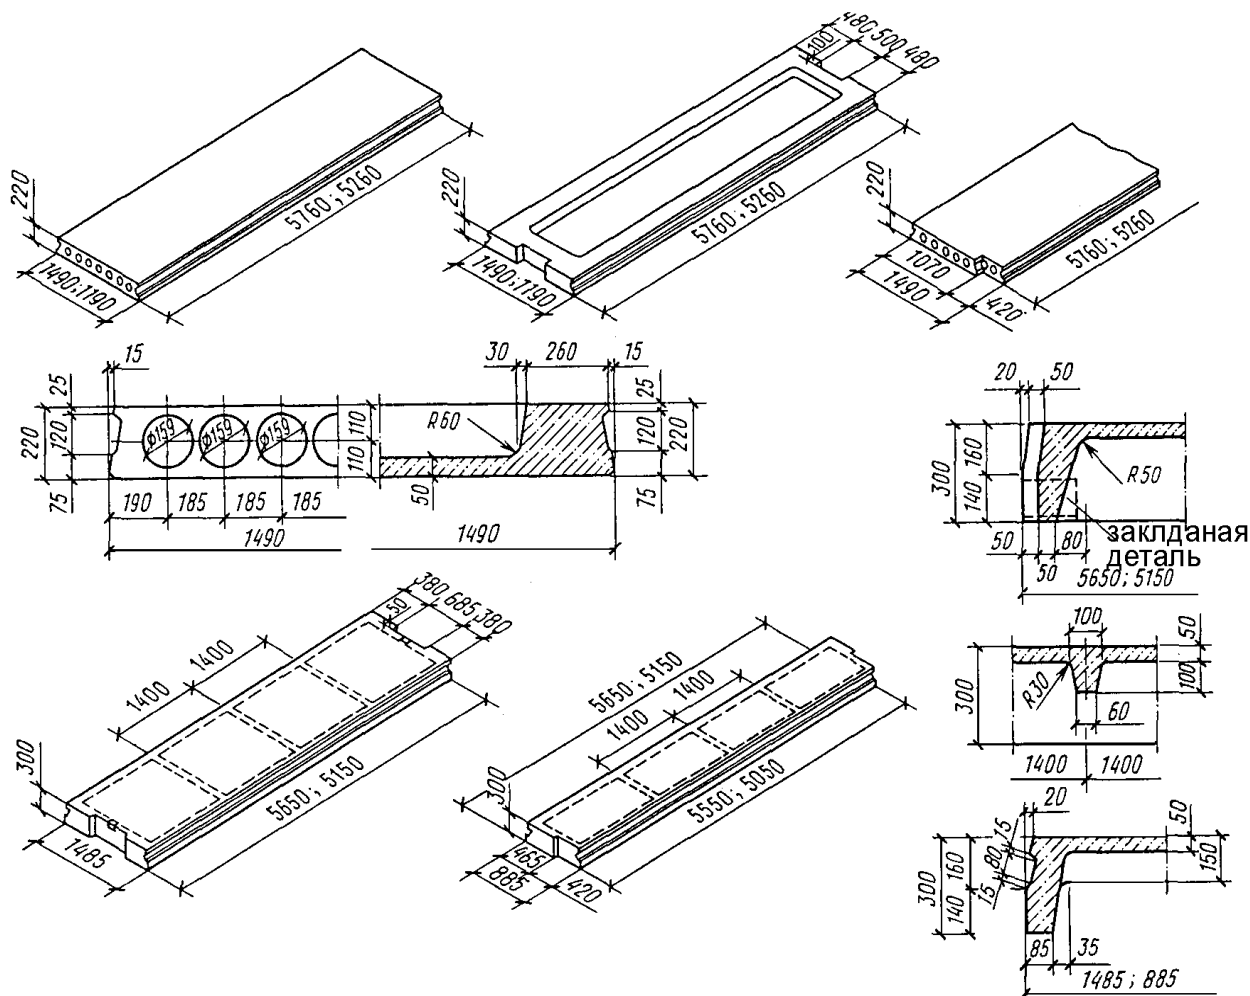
Многупустотные и ребристые плиты перекрытий (примеры)
